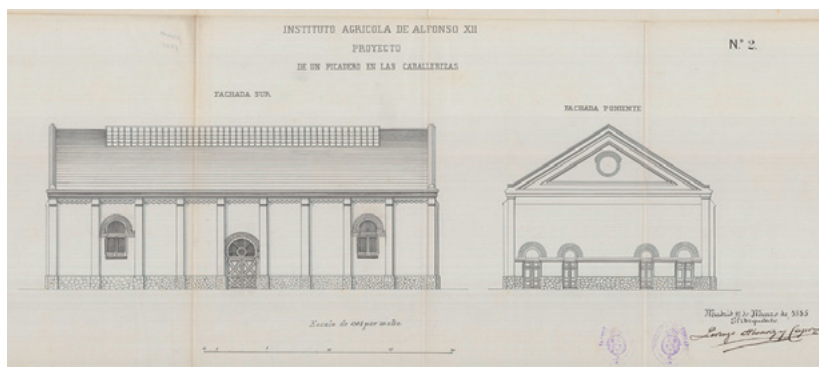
Proyecto de un picadero en las caballerizas. Lorenzo Álvarez y Capra. Fuente: AGA, Fondo Ministerio de Educación, IDD (05)001.025, Caja 31/08133.
